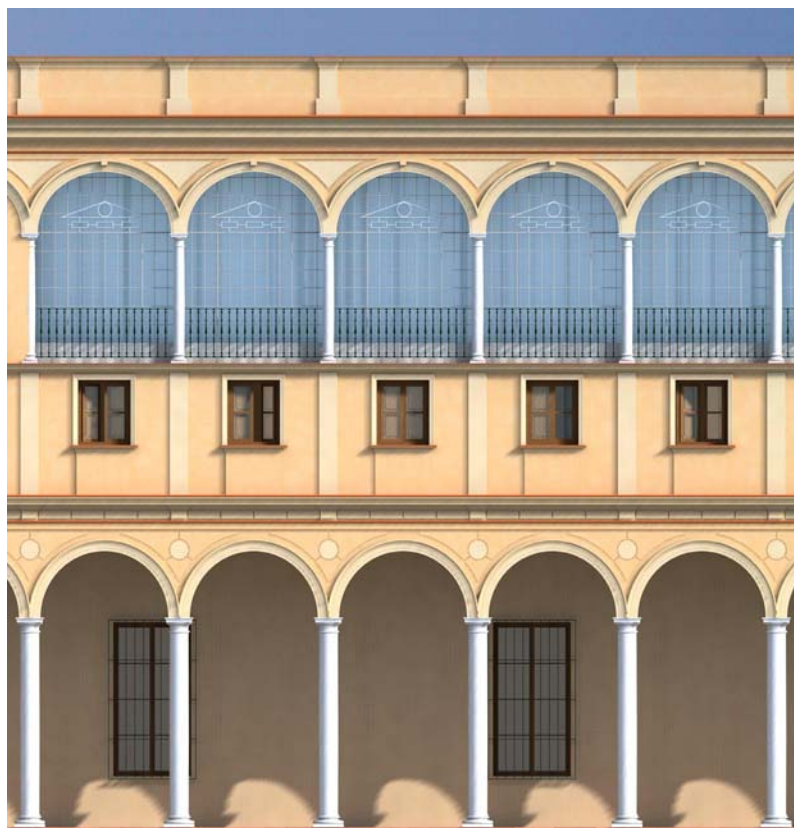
Detalle de la composición de la fachada de Lorenzo de Oviedo.
